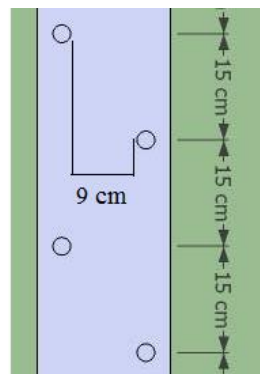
Detalhamento do espaçamento vertical entre as esperas do pilar
